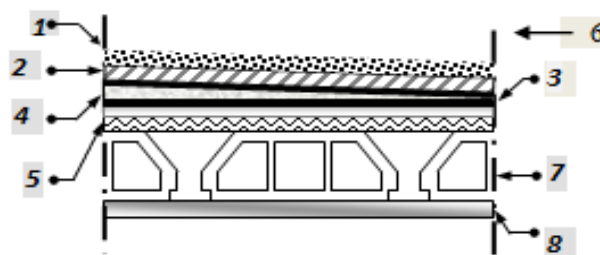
Constituants d'un plancher terrasse inaccessible.
